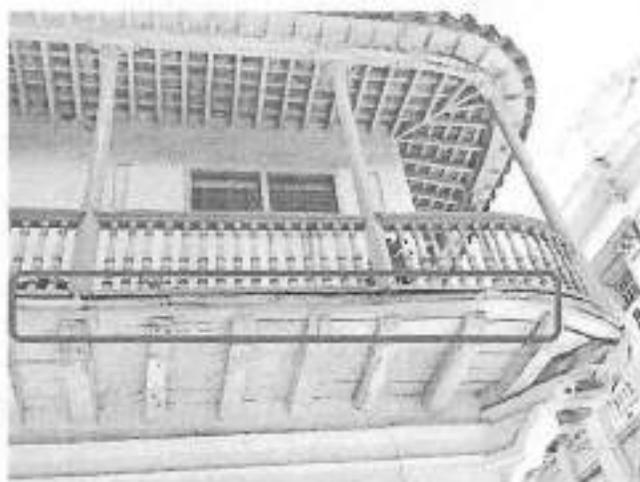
Pérdida de horizontalidad en perímetro del balcón (Fuente: Autor)
